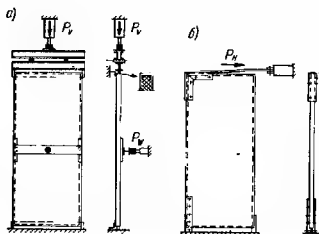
Устройство для испытания стенового элемента на предельную нагрузку
